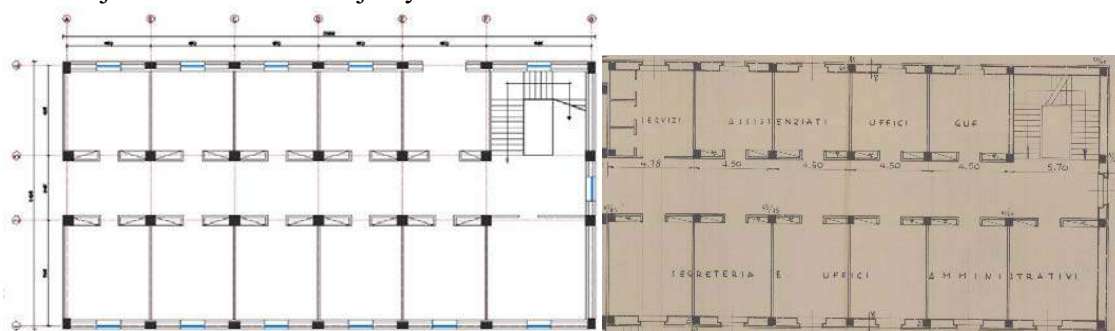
Planimetria e katit tip (kati përdhe dhe kati i parë): Majtas planimetria e sotme, Djathtas planimetria nga projekti original
